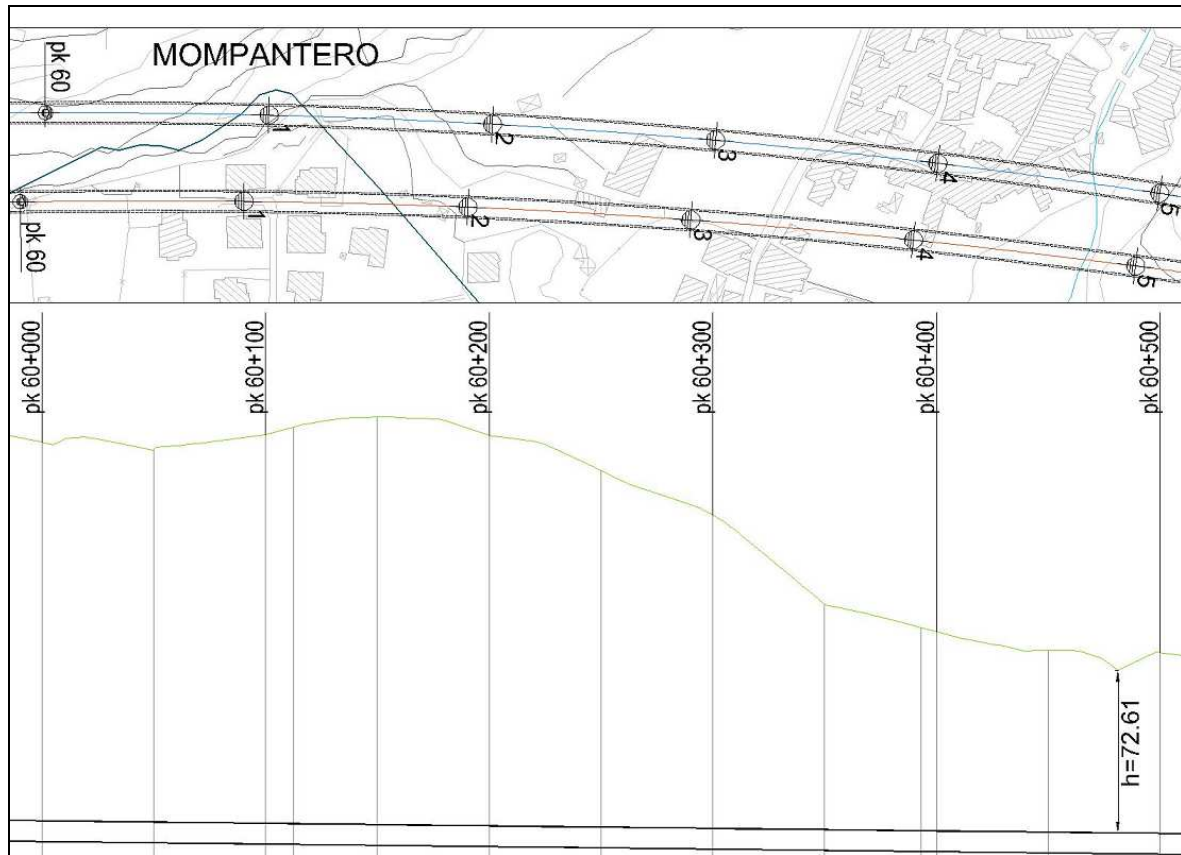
Stralcio Sottoattraversamento Mompantero - Planimetria + Profili 3di3
